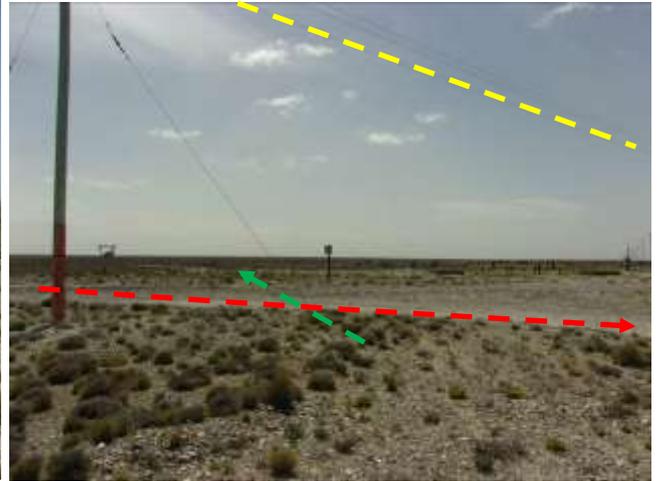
Emplazamiento de línea de inyección por futura locación. Interfieren camino de acceso (rojo) y línea eléctrica (amarillo). Foto en dirección NE.
